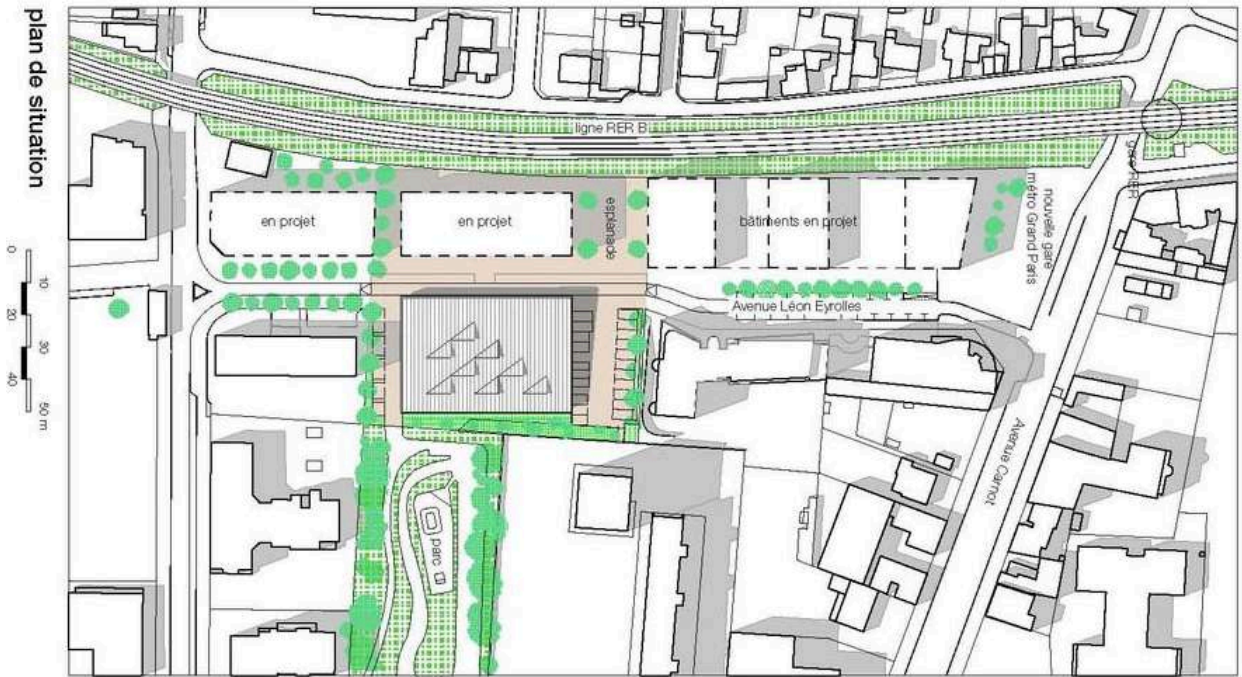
Генеральний план критого ринку Cachan [17].
